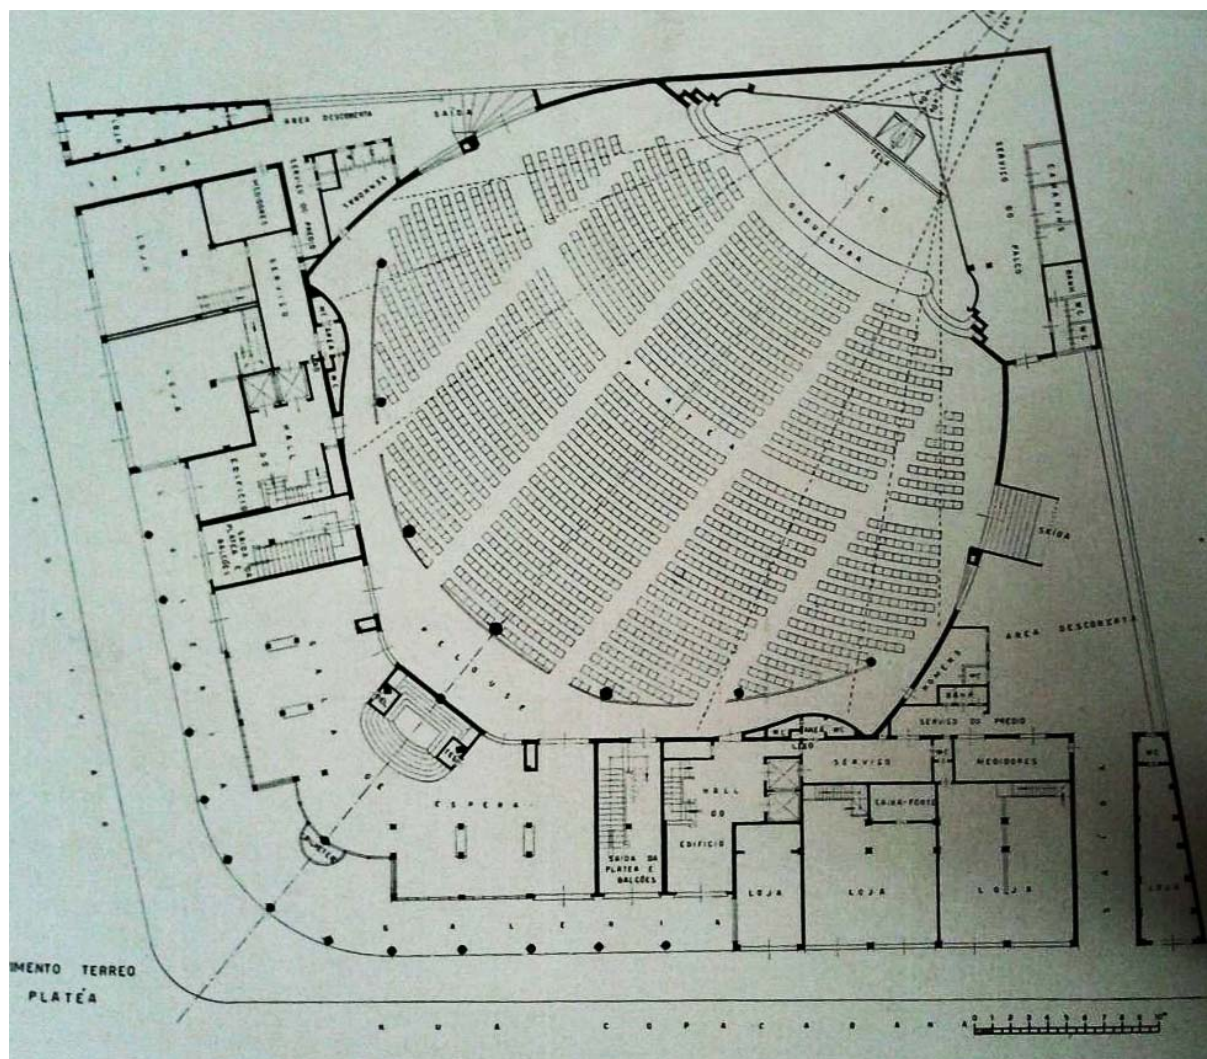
Planta do pavimento térreo do Cinema Roxy, publicado na *Revista Arquitetura e Urbanismo* em 1939.
